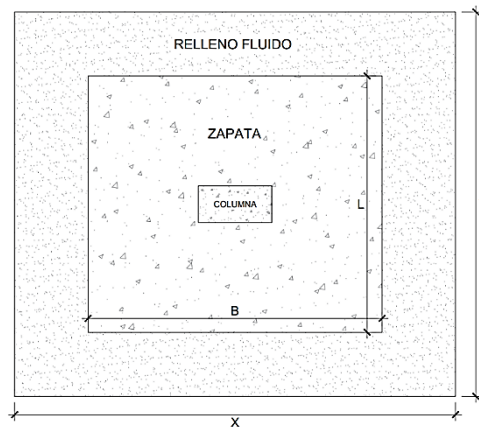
Ejemplo de cimentación rectangular sobre un suelo con refuerzo de relleno fluido (vista en planta)
